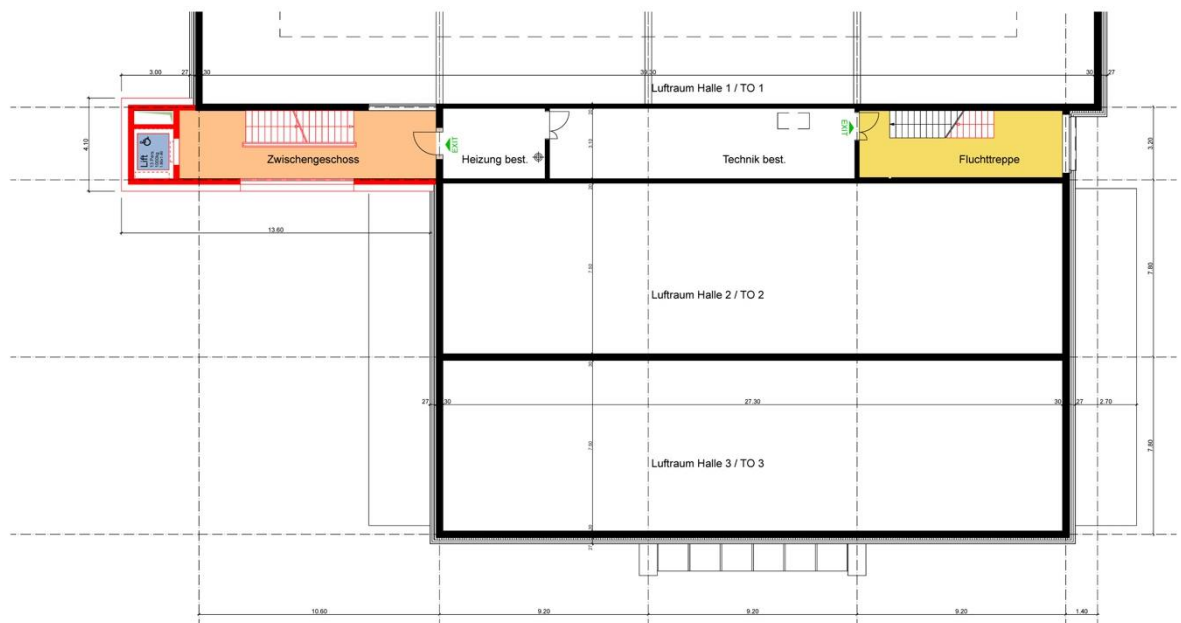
Aufstockung TO 4, MFK Verwaltung; Grundrisslayout, Zwischengeschoss
